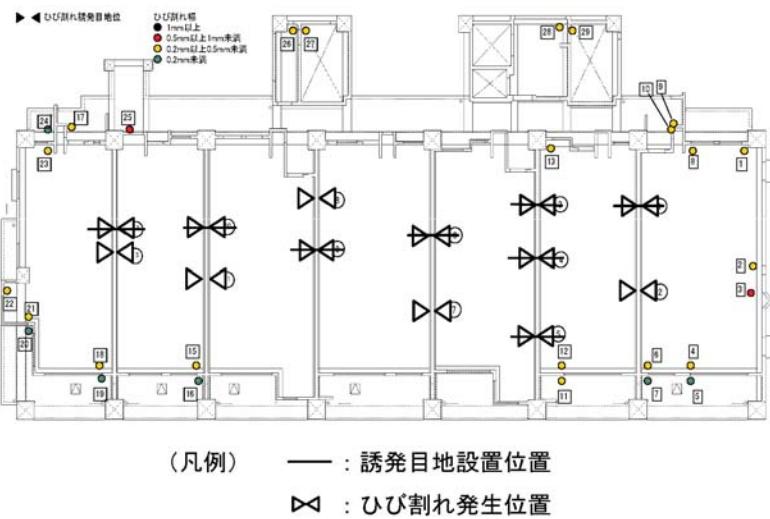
隠蔽部にのみ設置した誘発目地の位置とひび割れ発生位置の例
